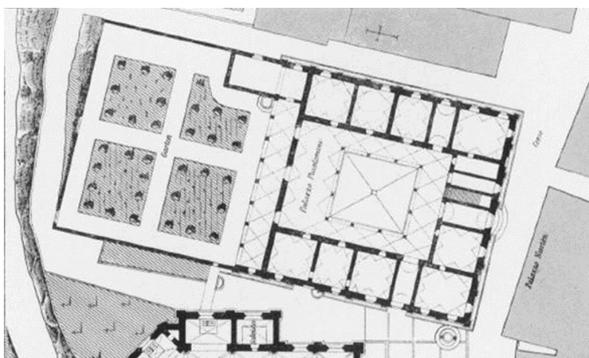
Bernardo Rossellino. Palazzo Piccolomini 1459-1464. Planimetria.
